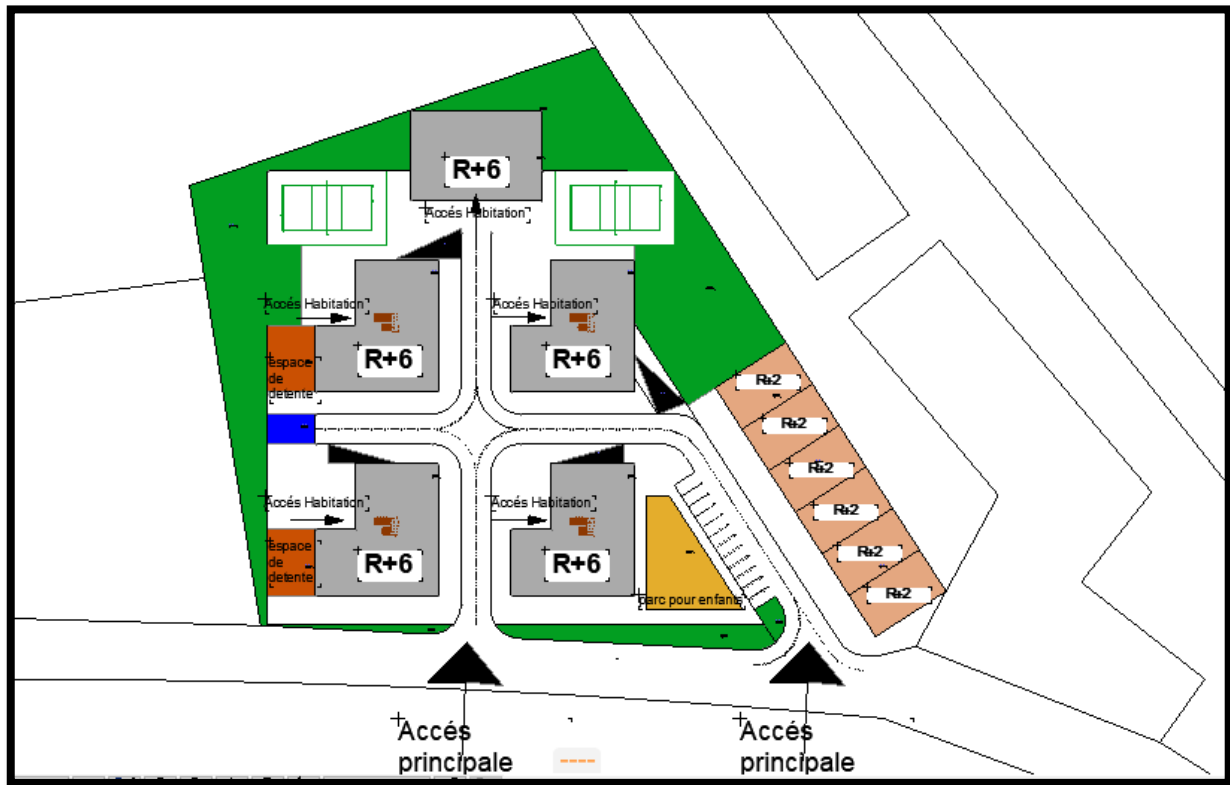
Plan d'Aménagement, Source : Auteur, 2024.
